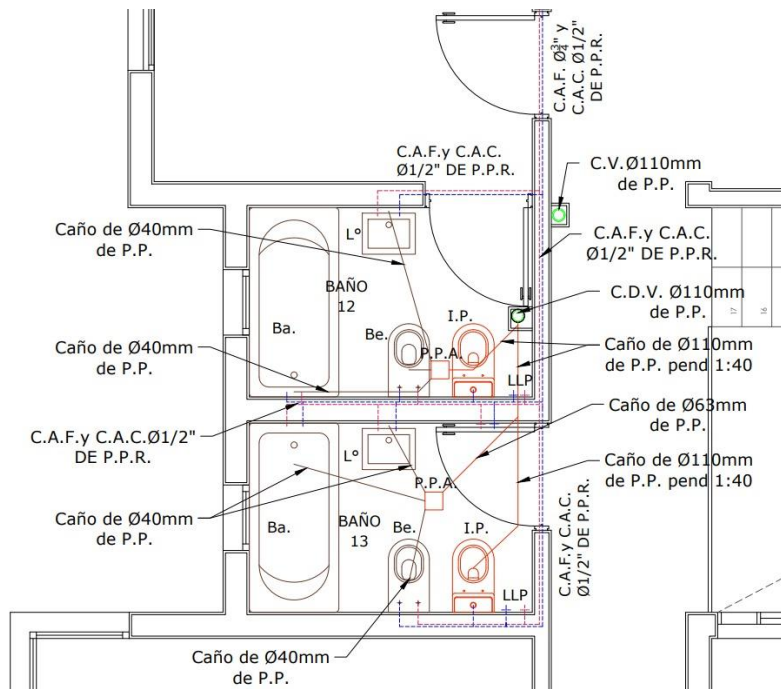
Ubicación de artefactos y dispositivos en planta alta
